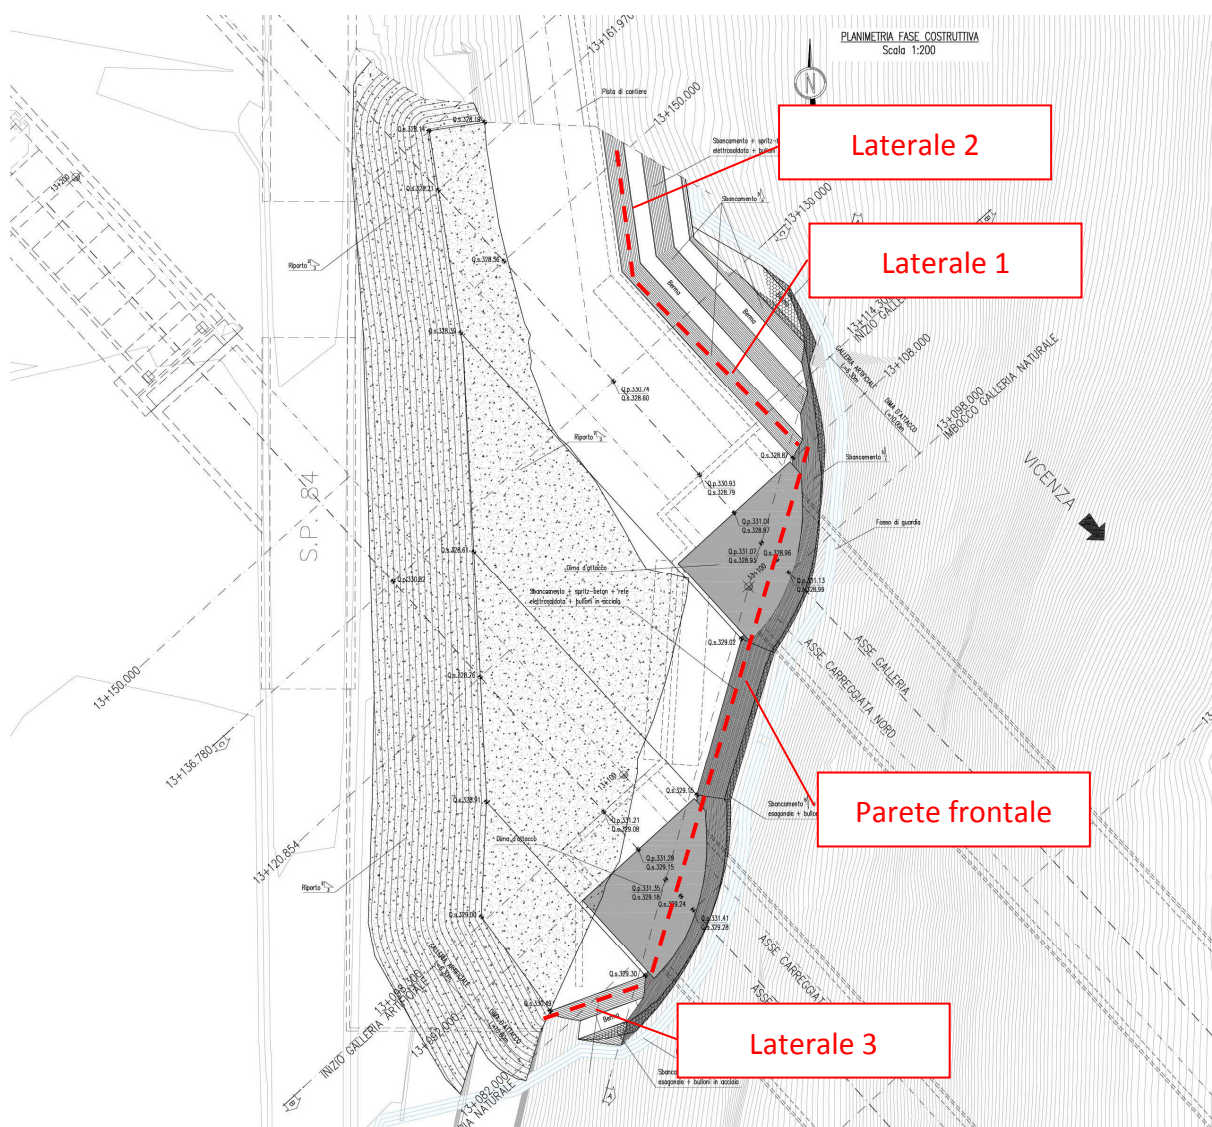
Stralcio planimetrico Imbocco Nord Galleria Pedescala
